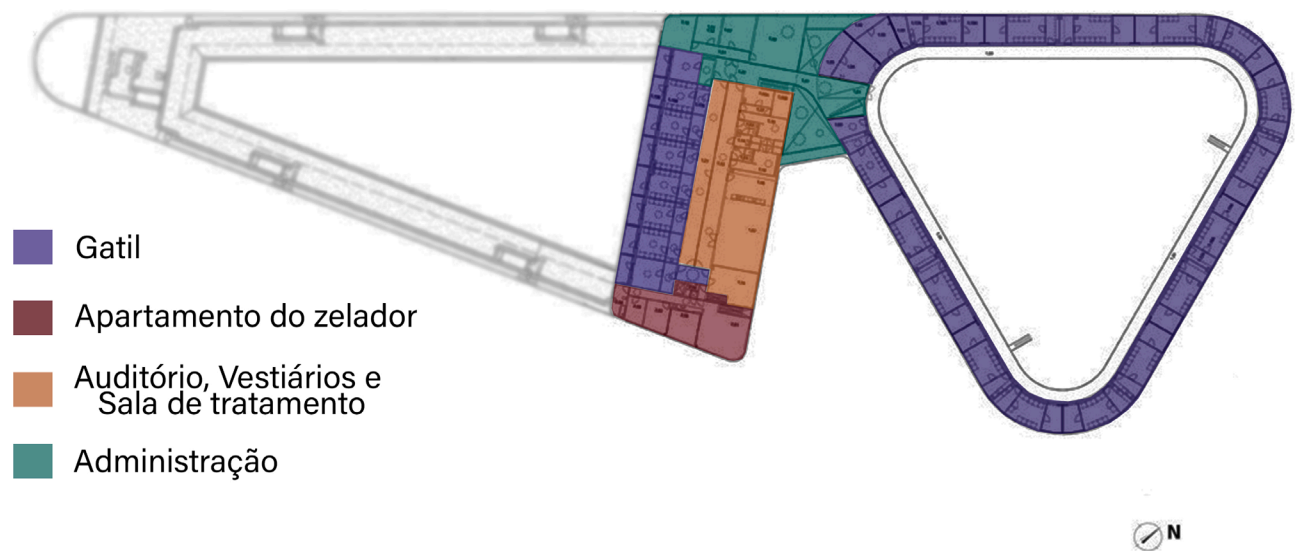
Setorização do primeiro pavimento do *Animal Refuge Centre
